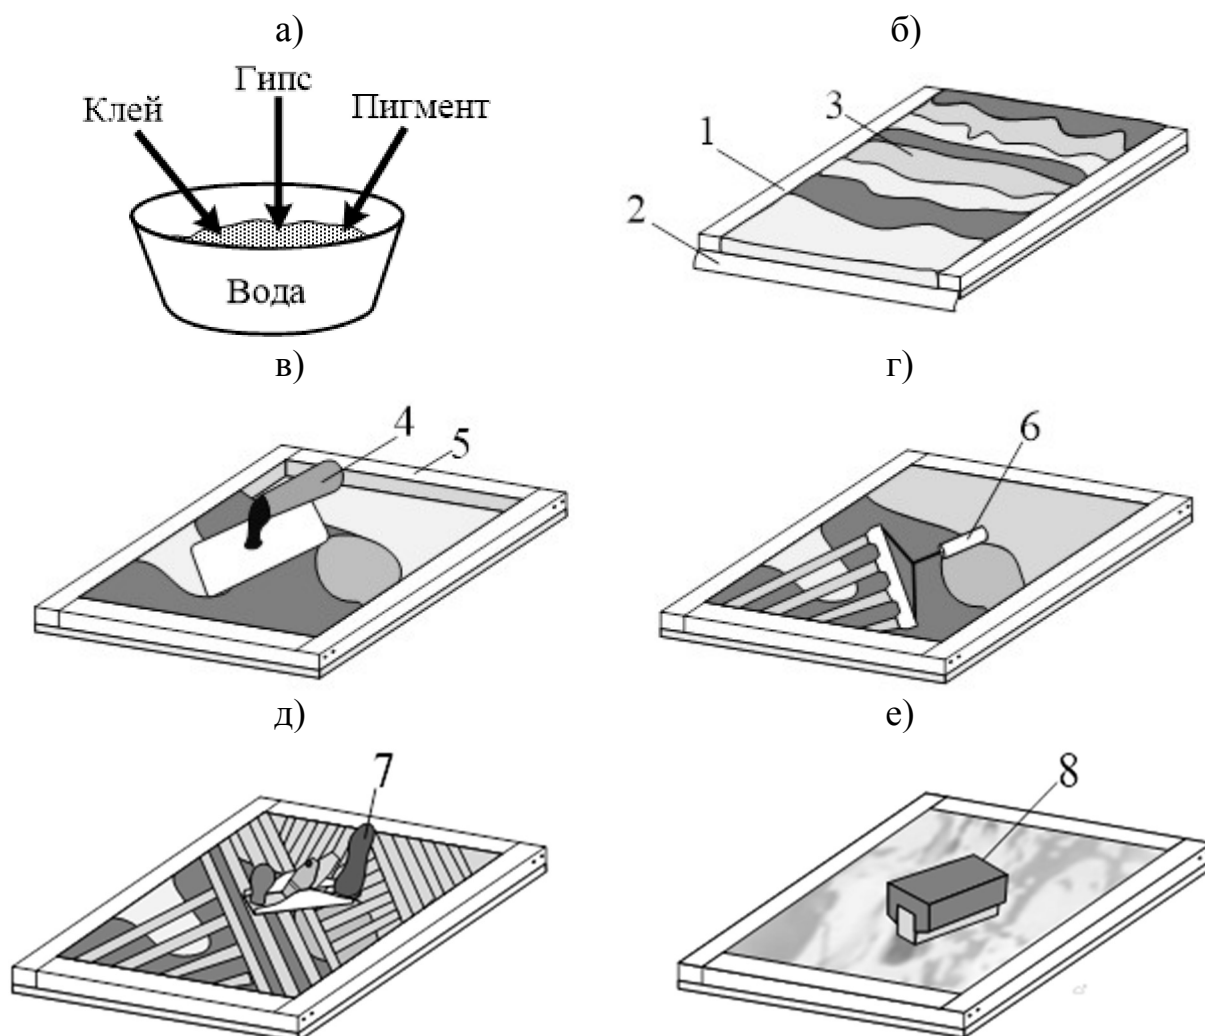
Изготовление оселкового мрамора: а – приготовление гипсового теста; б – подготовка мраморных слоев; в – нанесение гипсовой массы; г – грубая острожка; д – обработка шерхебелем и цинубелем; е – полировка оселком; 1 – щит; 2 – мешковина; 3 – цветные слои; 4 – кельма; 5 – форма; 6 – царапка; 7 – шерхебель; 8 – оселок
